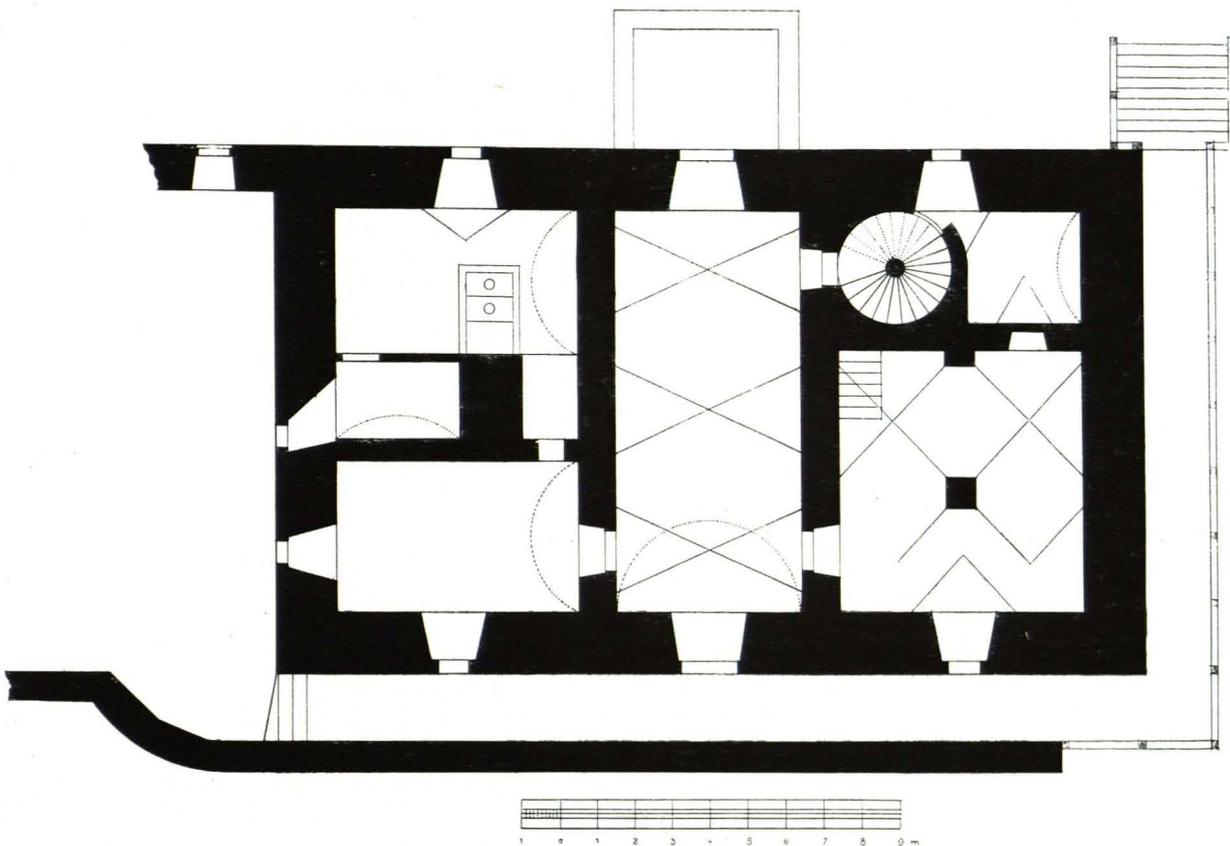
Schloß Glanegg, Grundriß 1:200 (S. 80)
